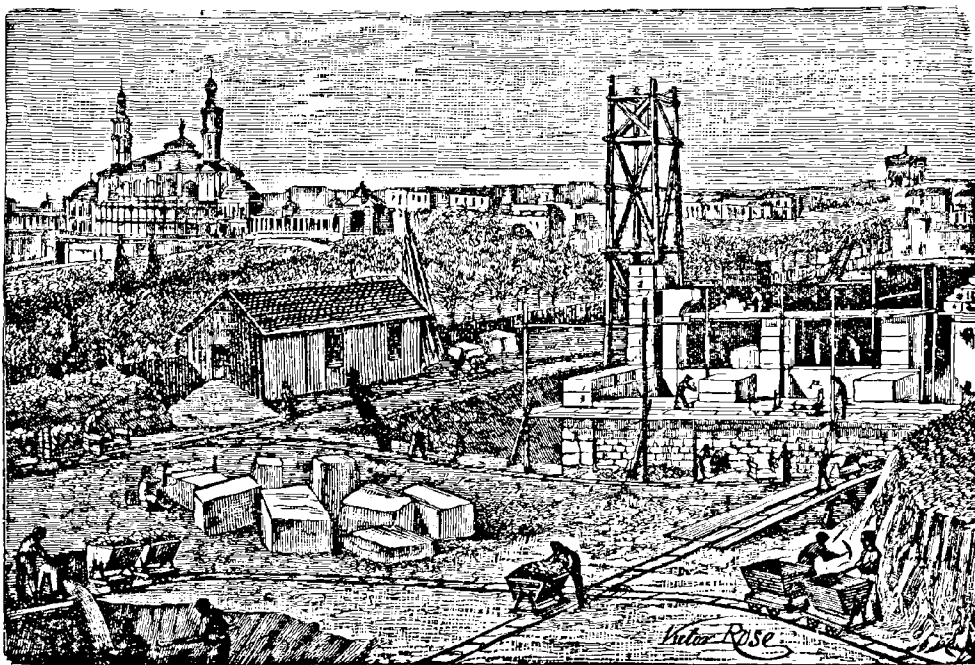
Application de la voie transportable Decauville aux travaux de construction en maçonnerie.
